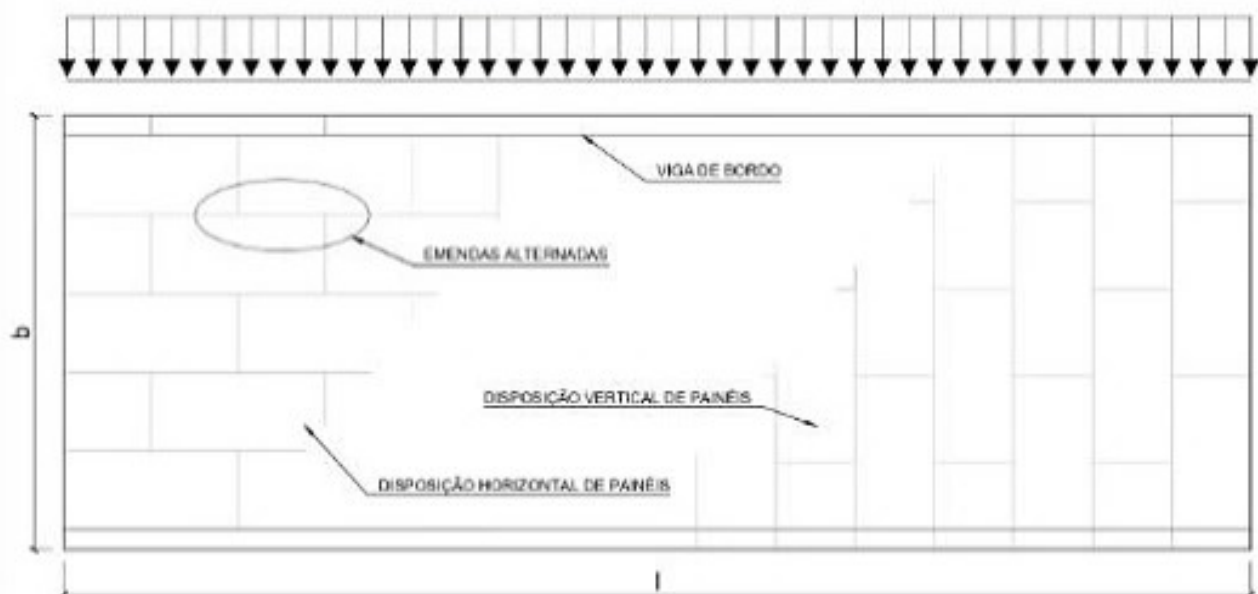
Carregamento de painel de diafragma e disposição dos painéis de contraventamento
